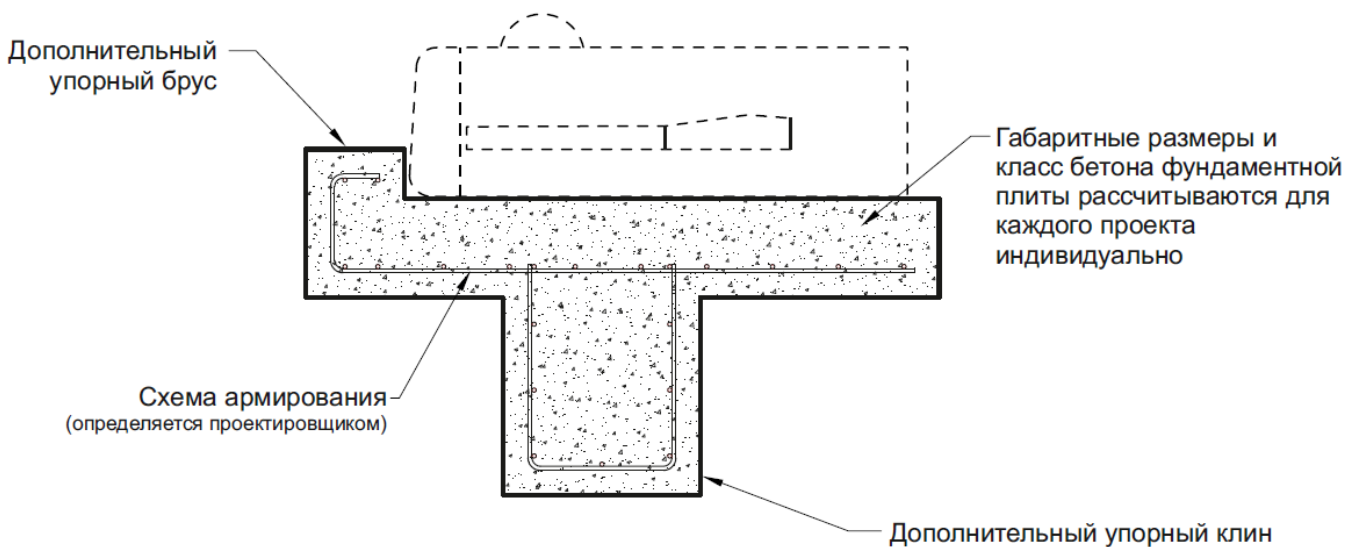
Принципиальная схема установки блоков на T-образный фундамент
